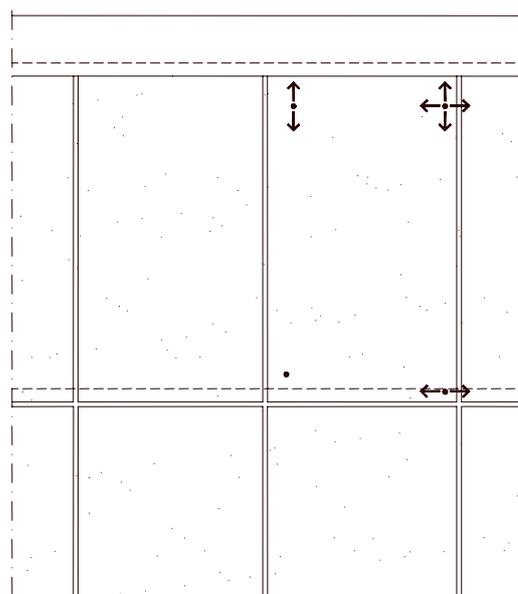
Elevação típica com a movimentação potencial de um painel fixado na base.
